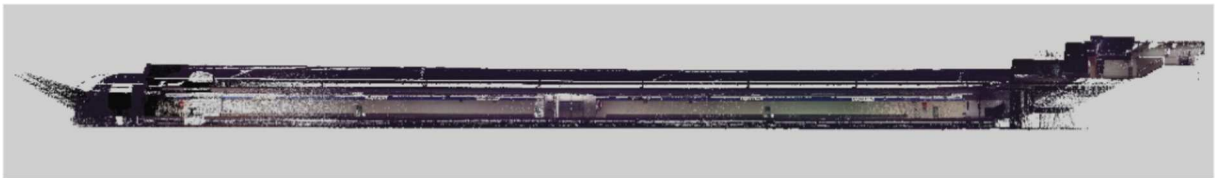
Ejemplo perfil longitudinal cara A.
